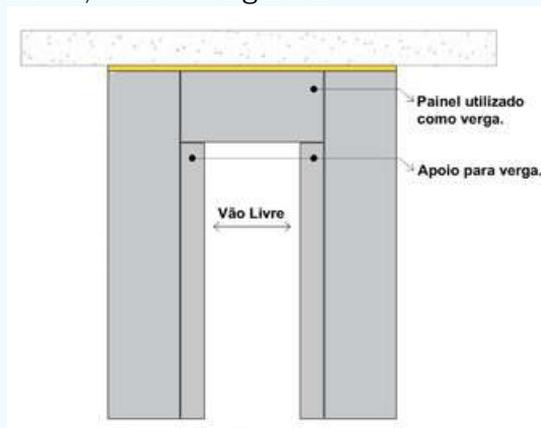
Detalhamento executivo de vergas sobre porta e janela
